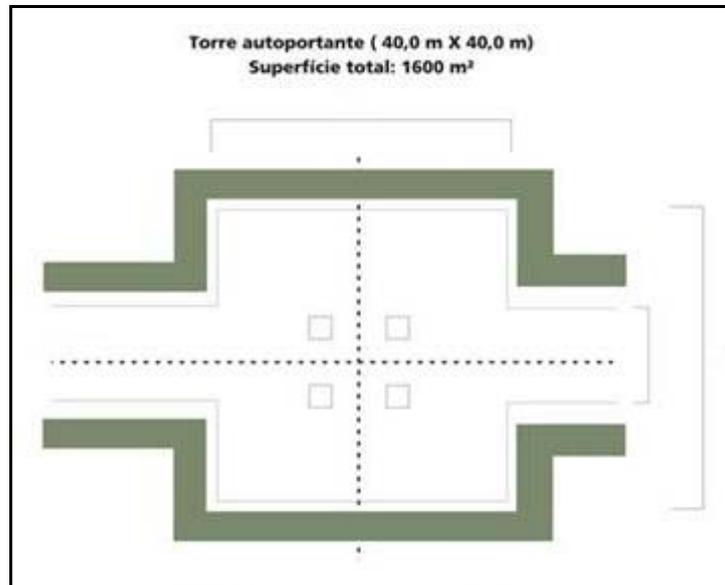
Croqui de supressão para implantação de torre autoportante.
